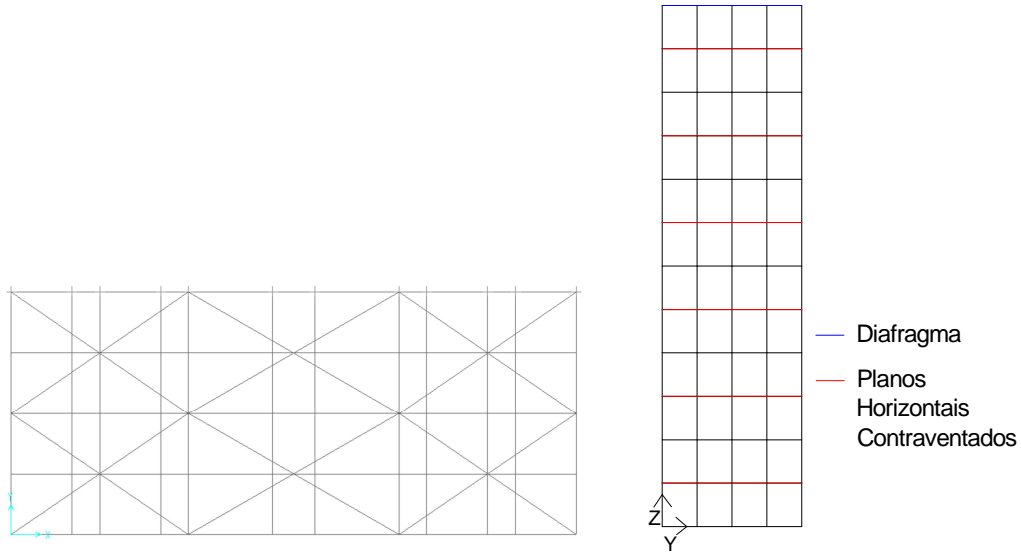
Configuração dos Planos de Contraventamento Horizontal Com Elementos de Contraventamento Grandes
